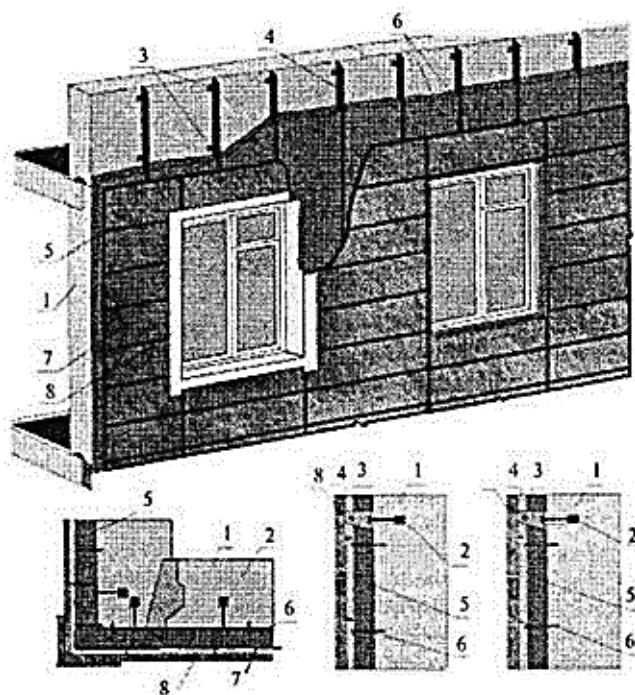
Конструктивные технологические схемы утепления и облицовки фасадов армоцементными плитами: 1 — стеновая панель; 2 — распорный анкер; 3 — кронштейн; 4 — вентилируемый зазор; 5 — утеплитель; 6 — направляющая; 7 — облицовочная панель; 8 — объемный элемент оконного обрамления.
